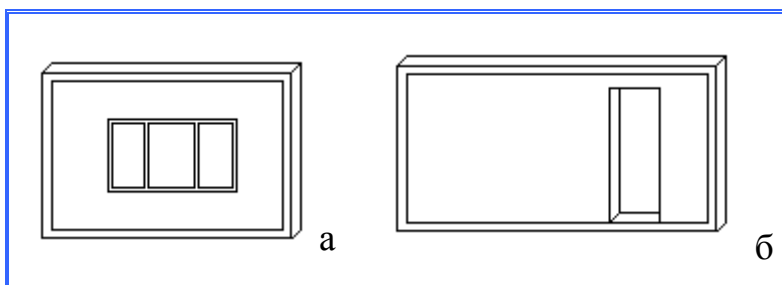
Збірні залізобетонні стінові панелі для громадських і житлових будівель: а – зовнішня; б – внутрішні
